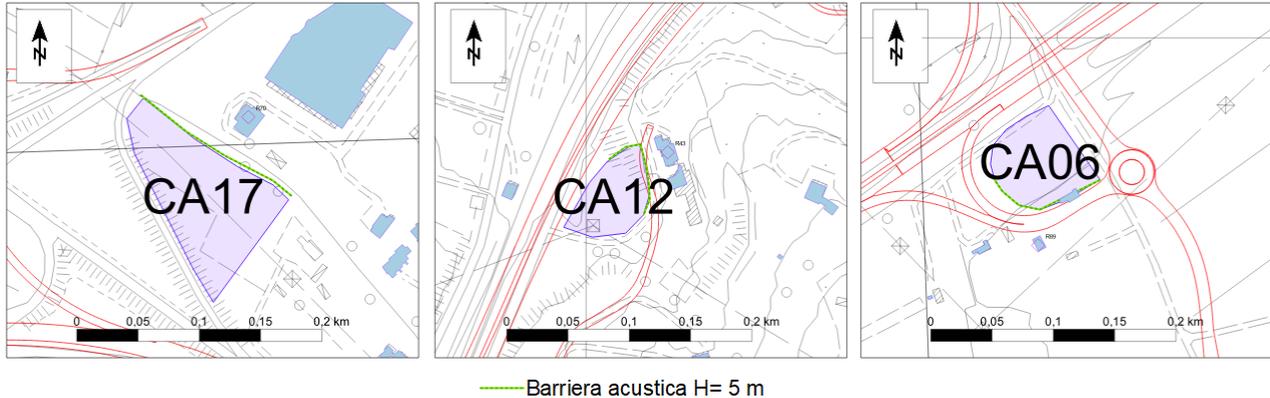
Barriere acustiche provvisorie sui cantieri.
